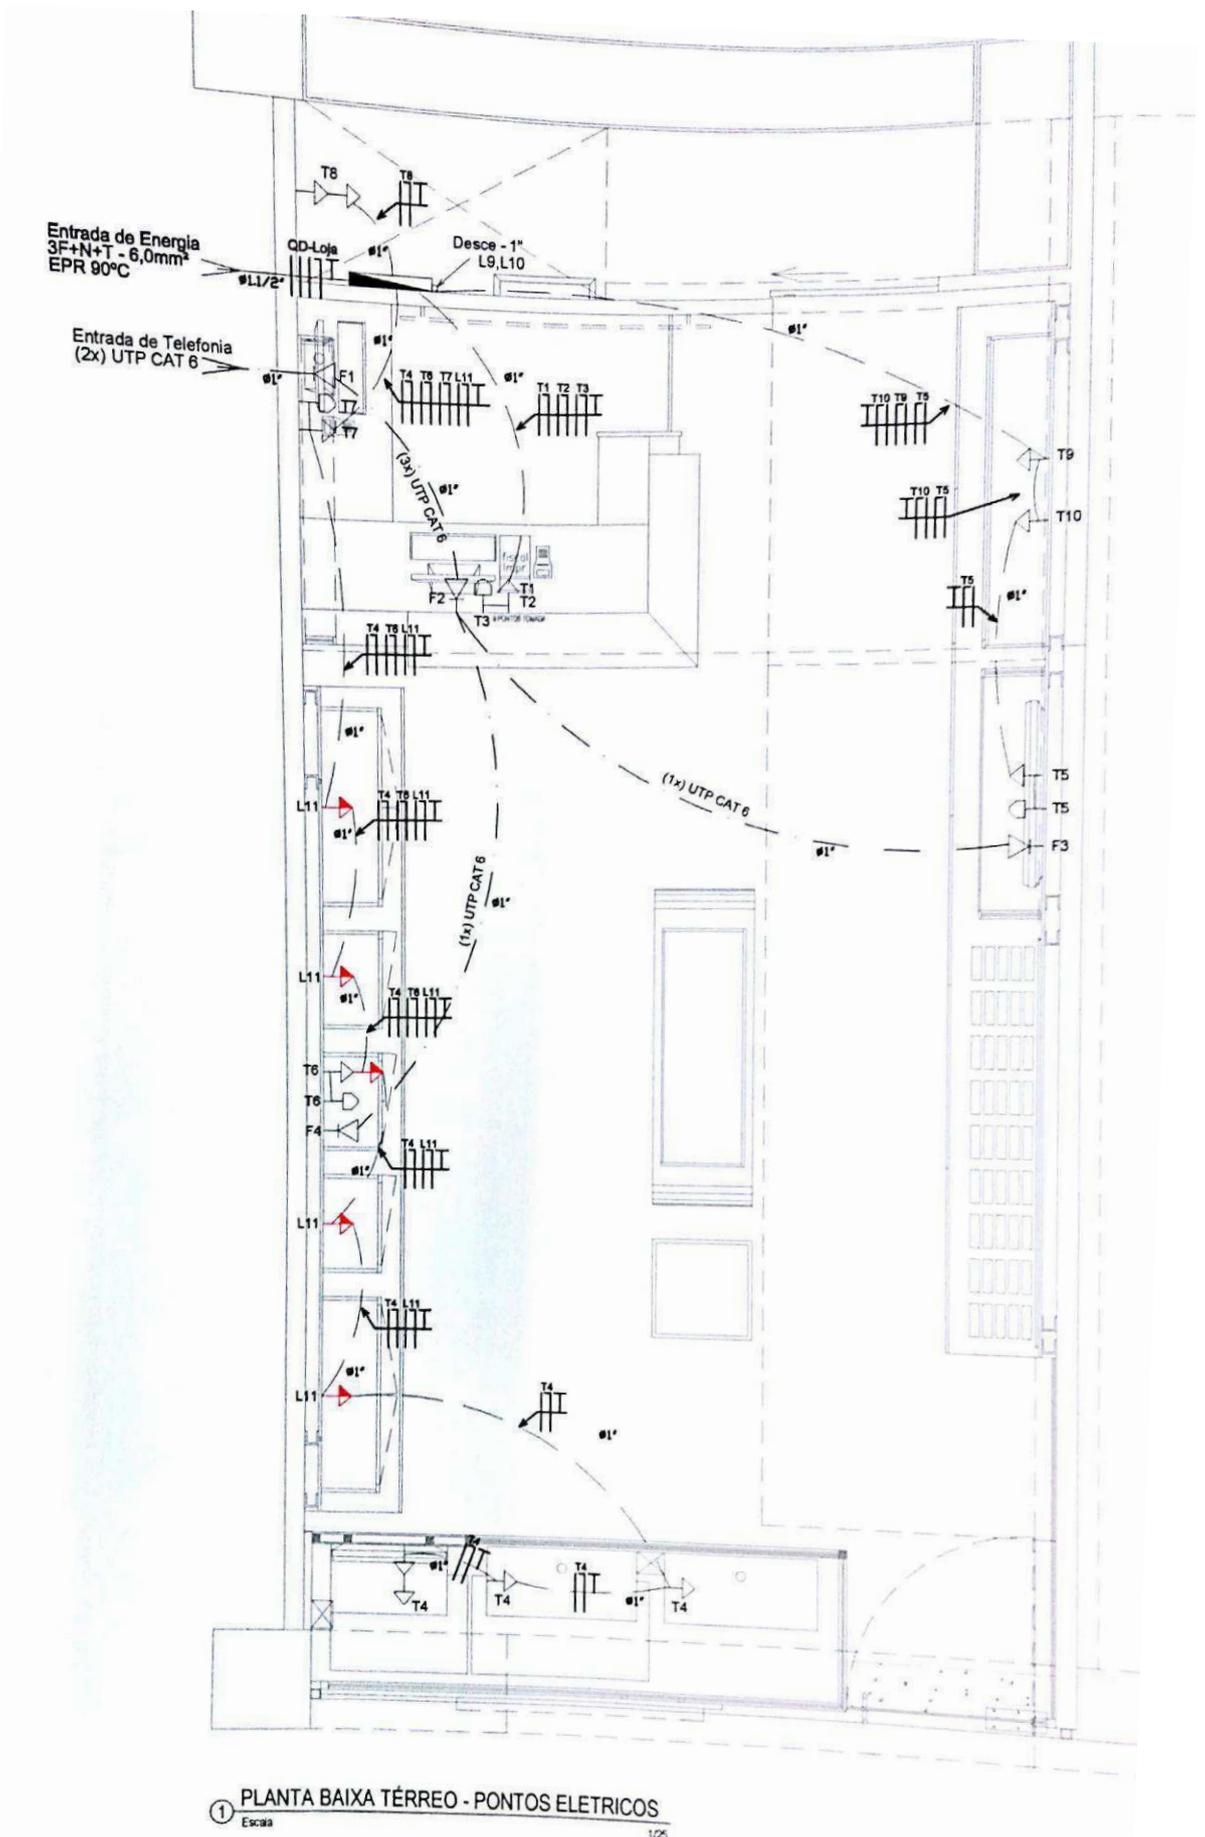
Planta baixa com projeto atualizado de tomada e telefone do térreo da loja Watt
